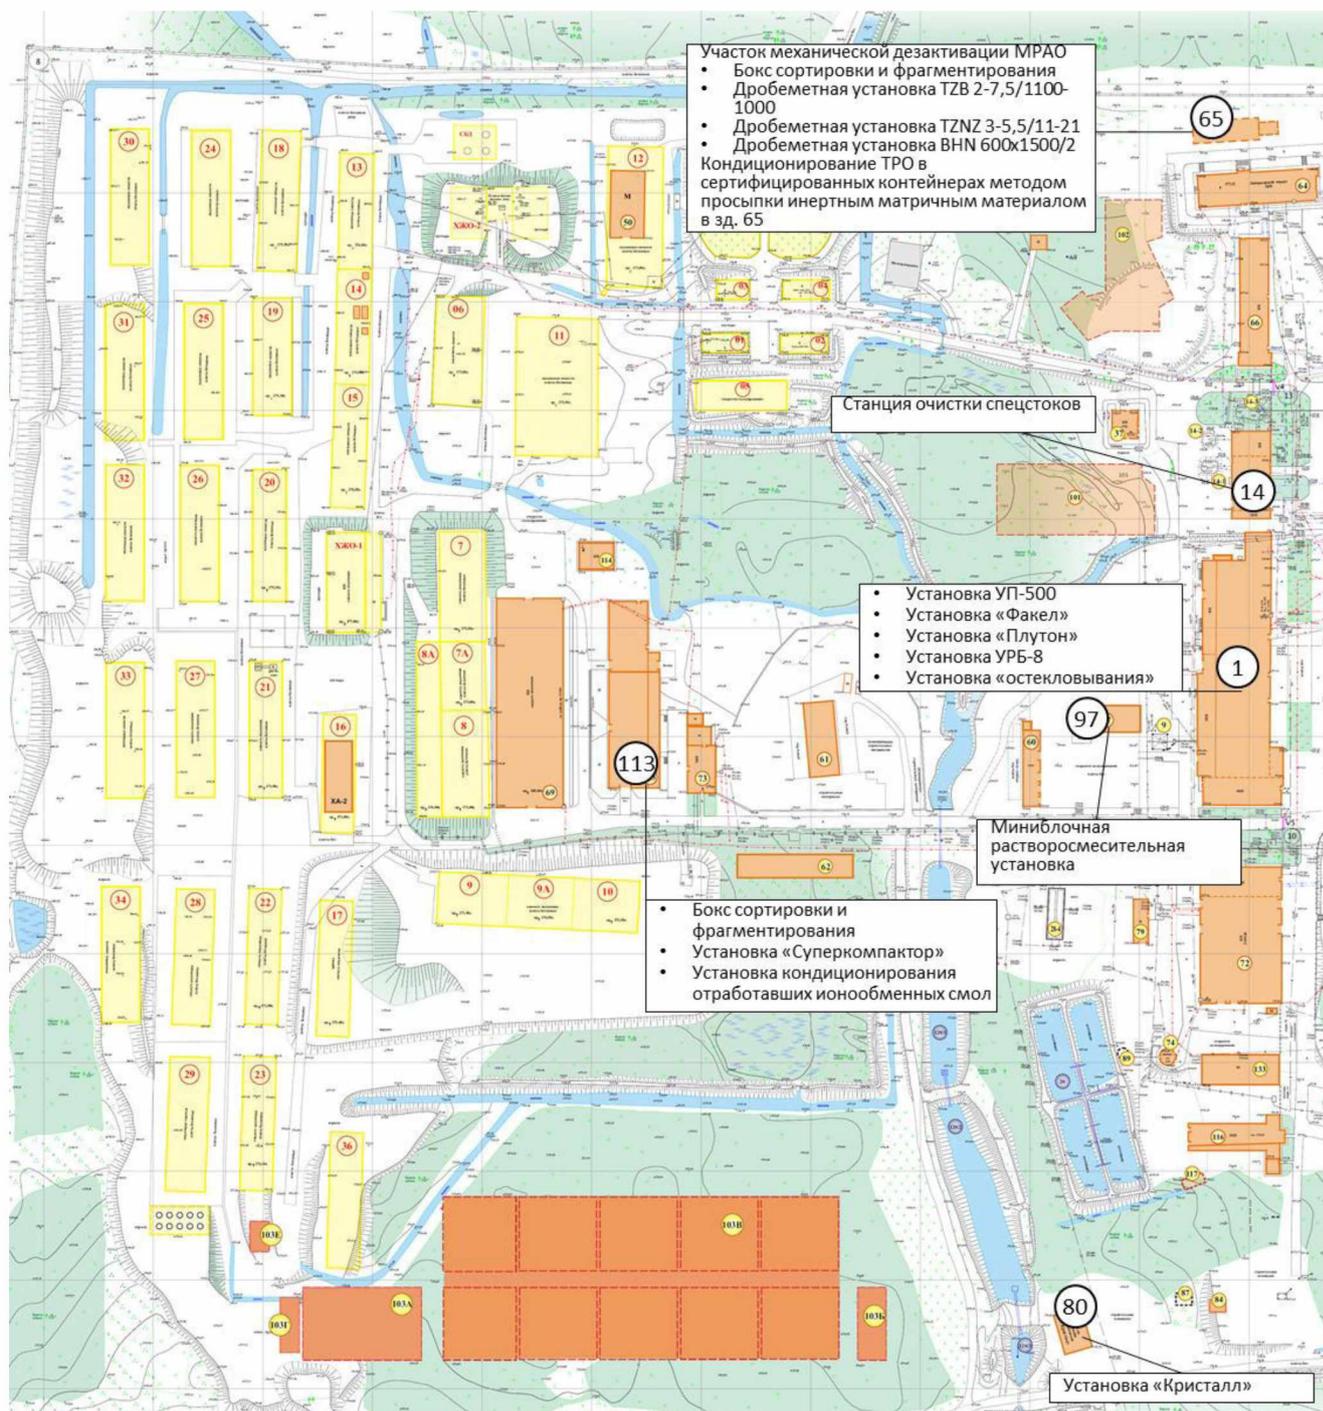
Схема расположения установок в зданиях промплощадки ФГУП «РАДОН»
